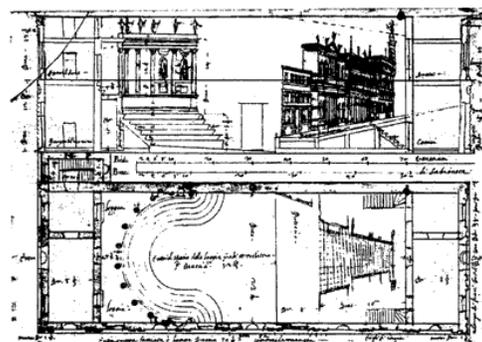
Seção longitudinal de Bertotti Scamozzi 1776. (Fonte: ARCHITETTURE PALLADIANE, 1999)
